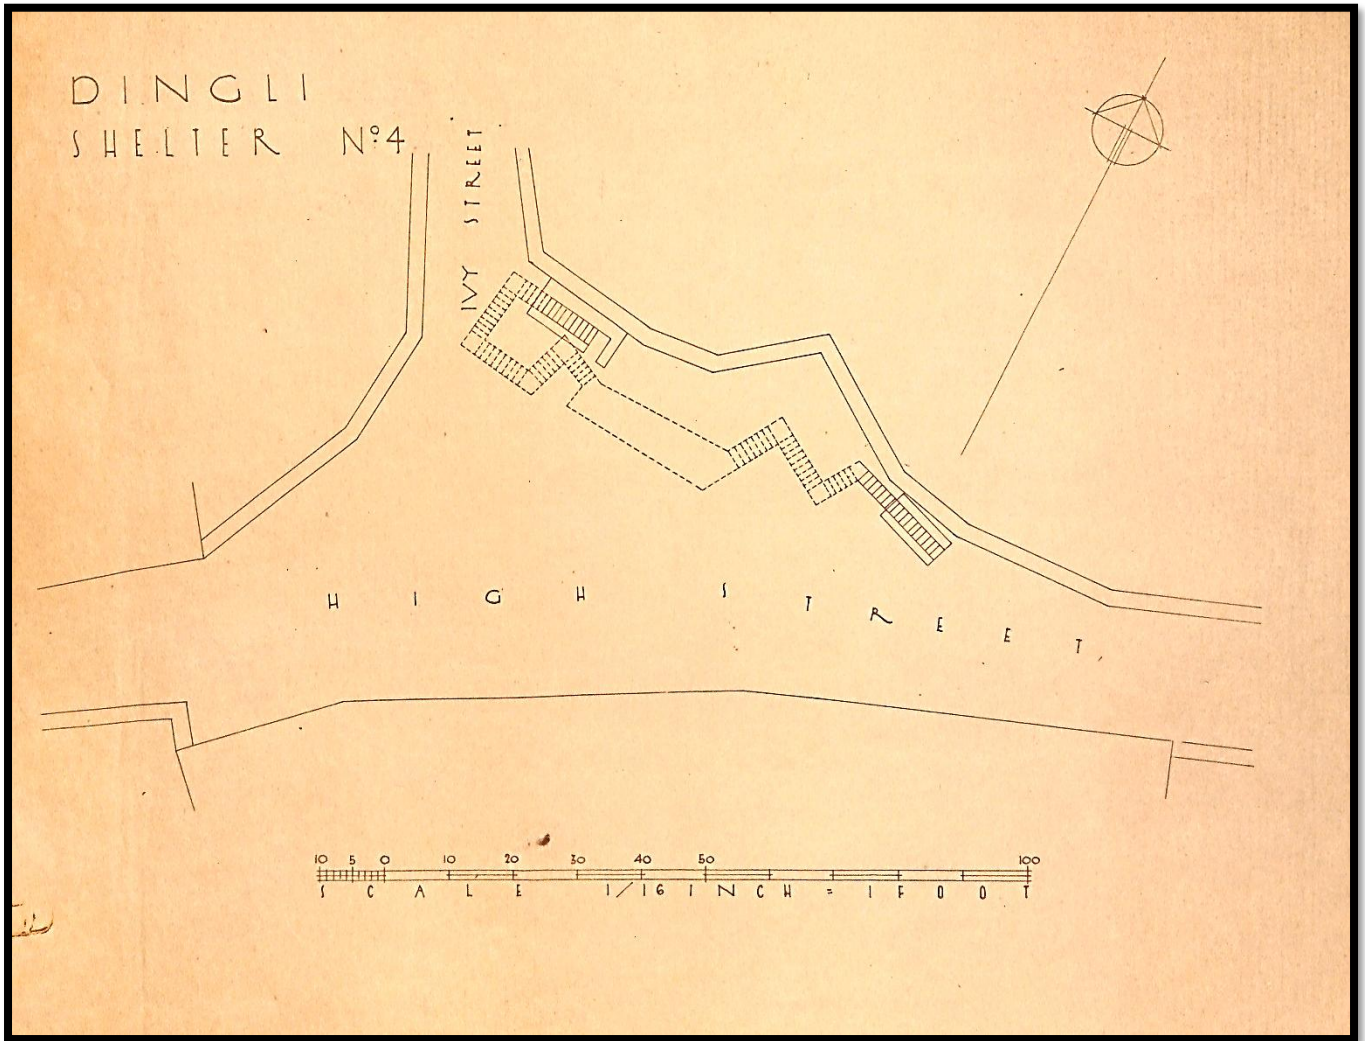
Planta do Abrigo nº 4 "Ivy Street – High Street."
